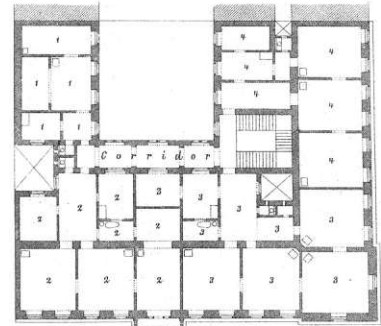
Grundriss Mezzanin, 1., 2. und 3. Obergeschoss, Kolin-gasse 5 - F. Dehm und F. Olbricht, 1886
